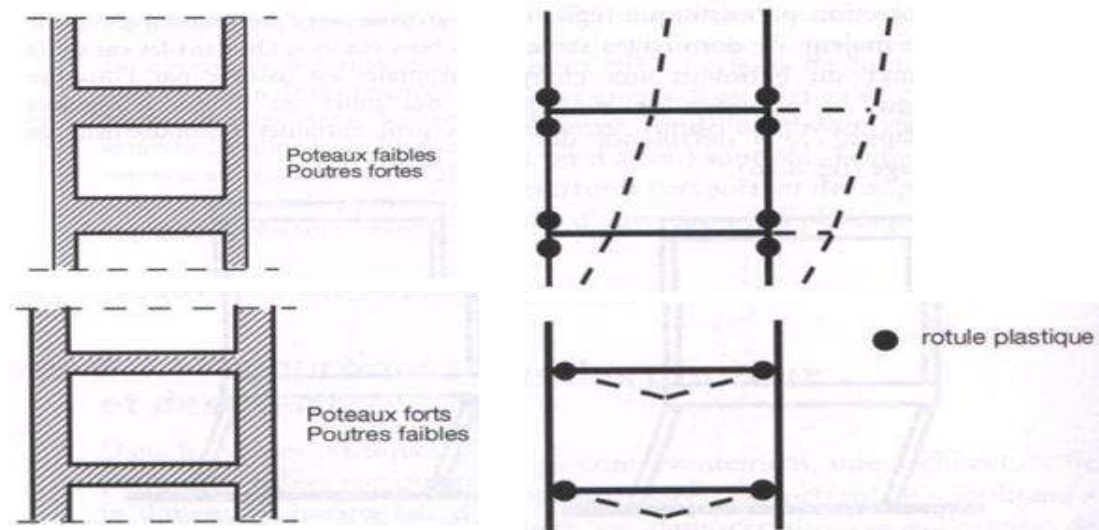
Le principe «poteaux forts-poutres faibles» ou «poutres fortes-poteaux faibles»[21].
